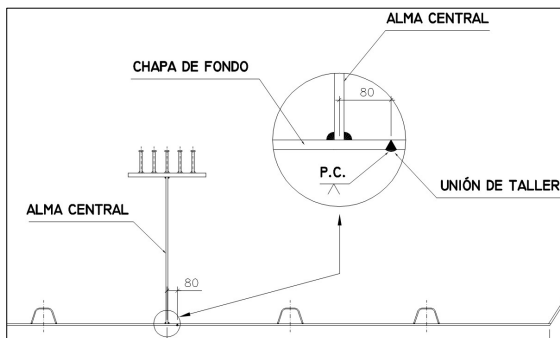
Ubicación empalme longitudinal fondo de cajón.
